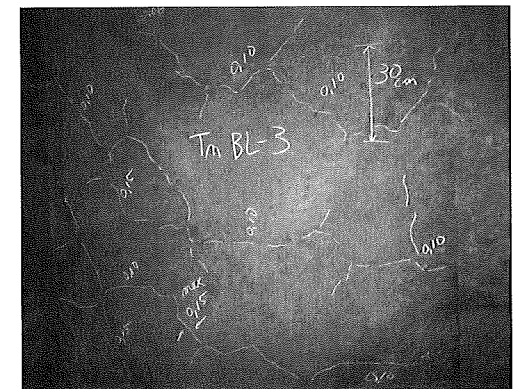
覆工コンクリート乾燥収縮ひび割れ
